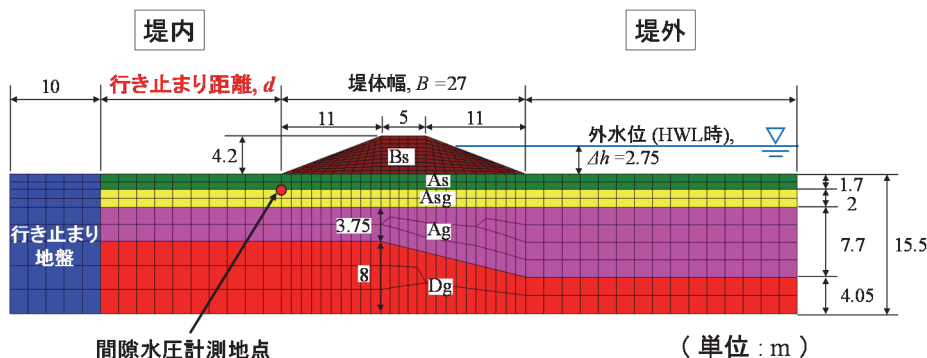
解析モデル概要図（常呂川左岸 KP26.8 地点）
